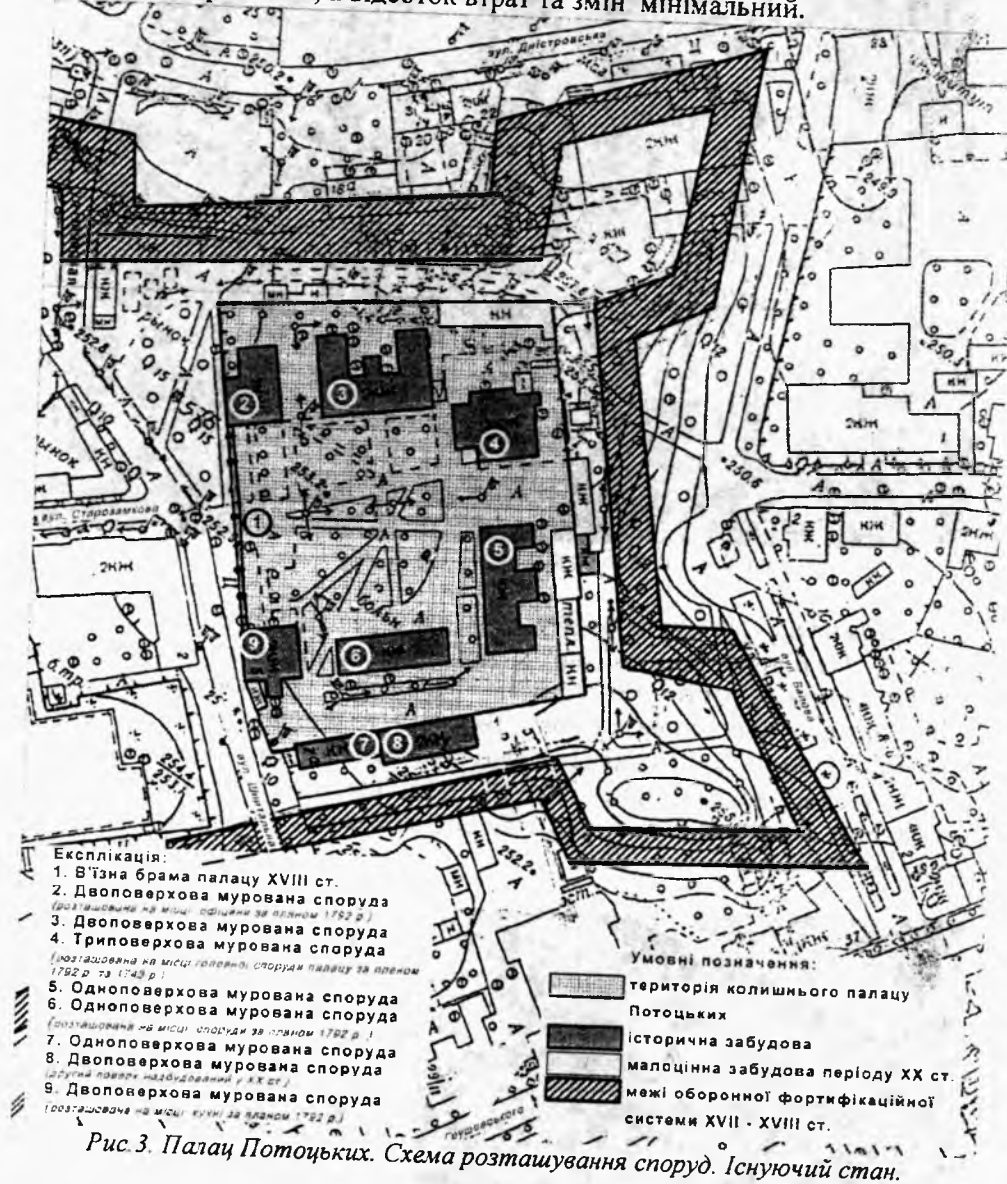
Палац Потоцьких. Схема розташування споруд. Існуючий стан.
